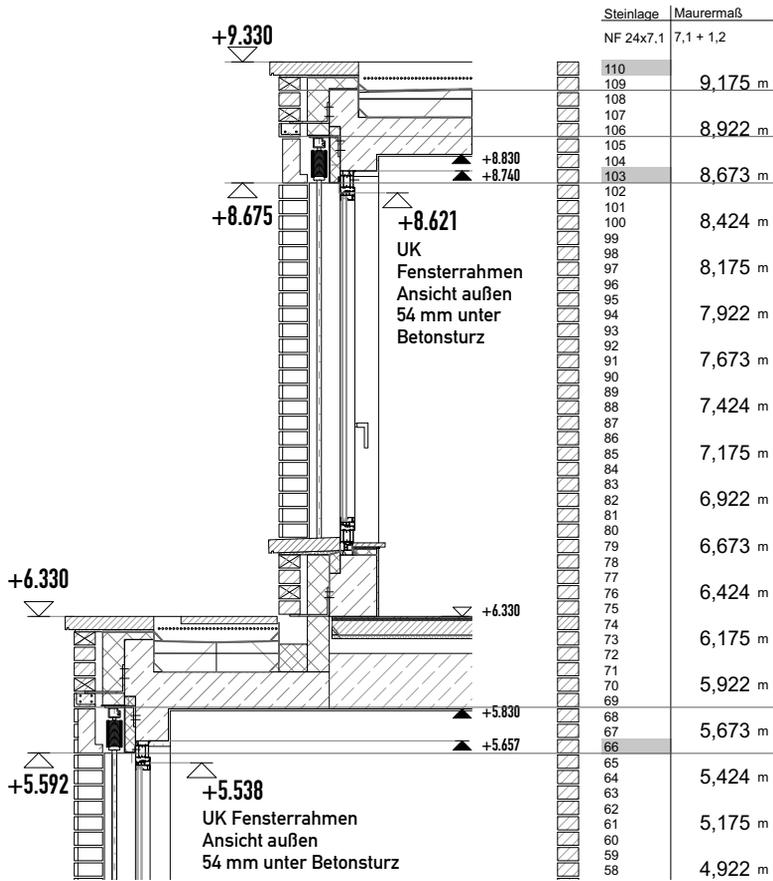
Detailschnitt der Fassade mit Vermassung der Vormauer – Klinkerschale des Musterprojektes
